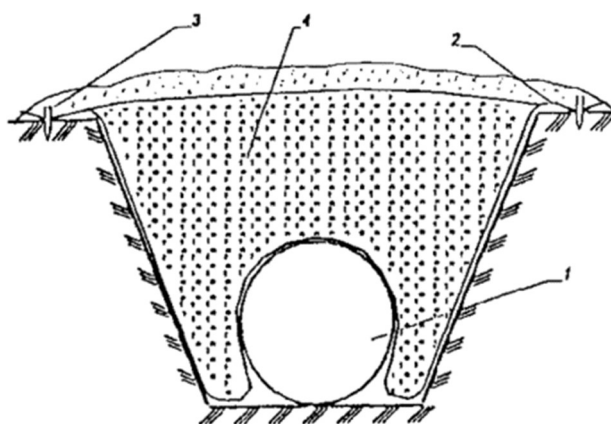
Способ балластировки газопроводов минеральным грунтомзасыпки с использованием полотнищ из НСМ (для песчаных грунтов)
